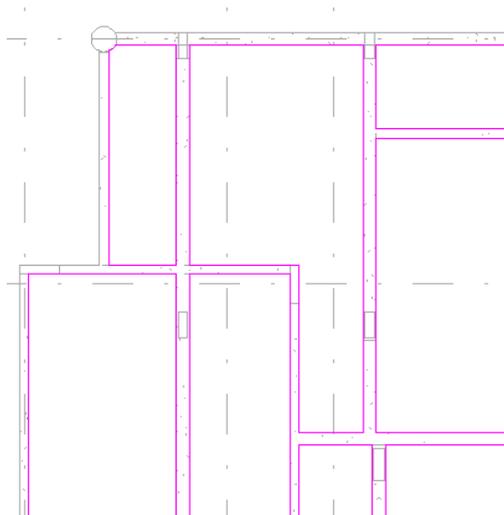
Croqui da Construção dos Limites da Lajes em Trecho do Pavimento Superior
